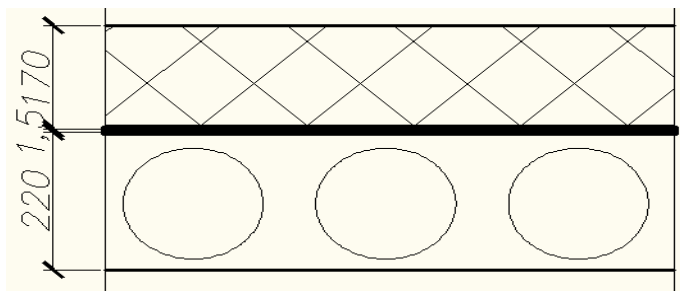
Конструкция чердачной плиты перекрытия
